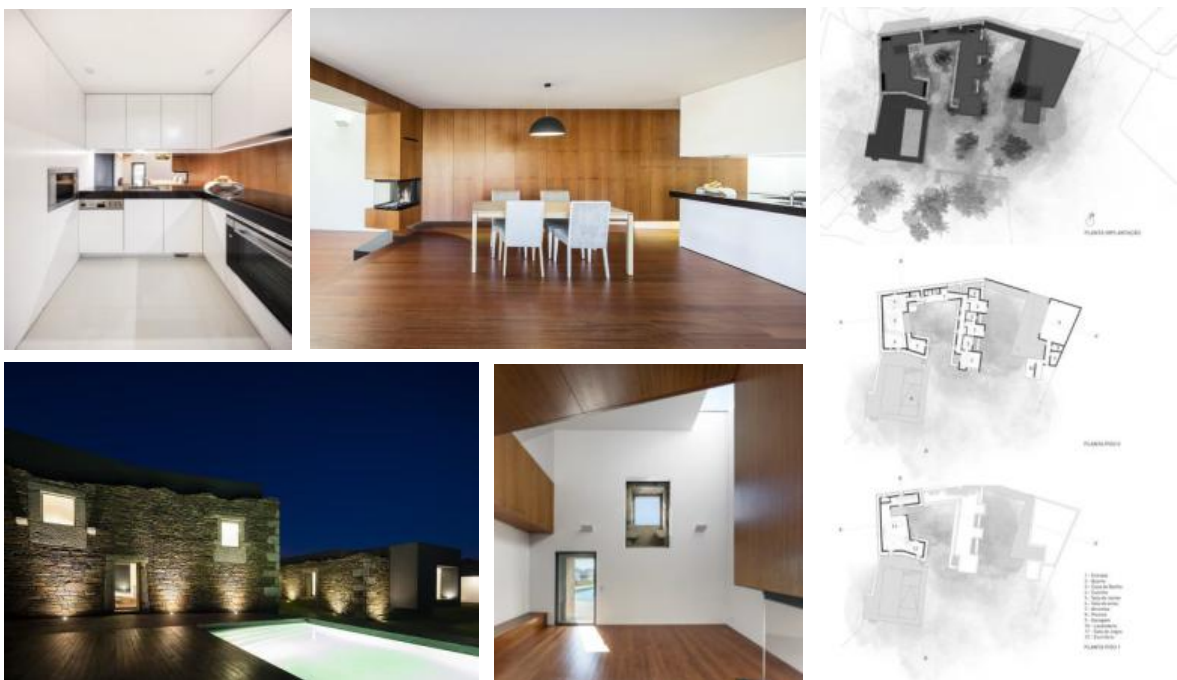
Vigário House e respetiva planta. Fotos de Fernando Guerra. Fonte: AND-RÉ
